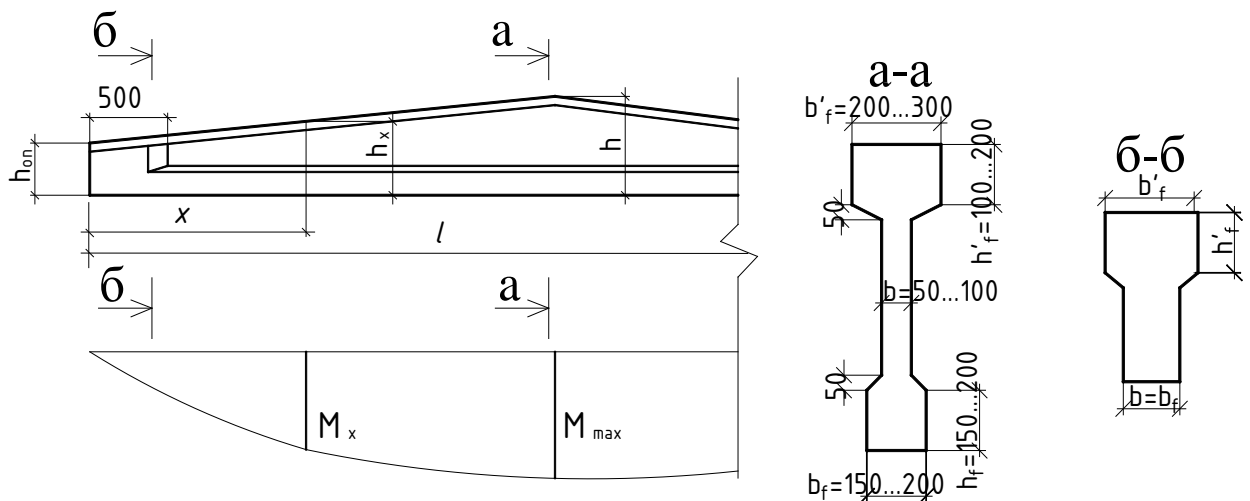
Расположение расчетного нормального сечения и поперечные сечения балки
